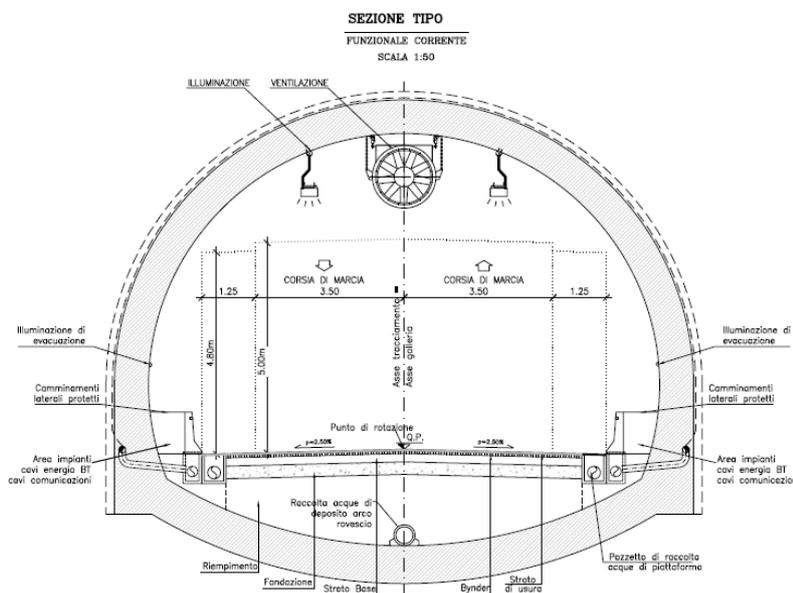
Sezione corrente della galleria tipo C2 Anas
